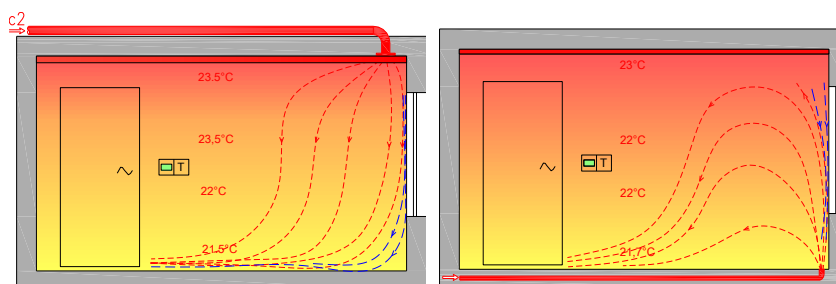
Kombinace horního a spodního přívodu vzduchu
